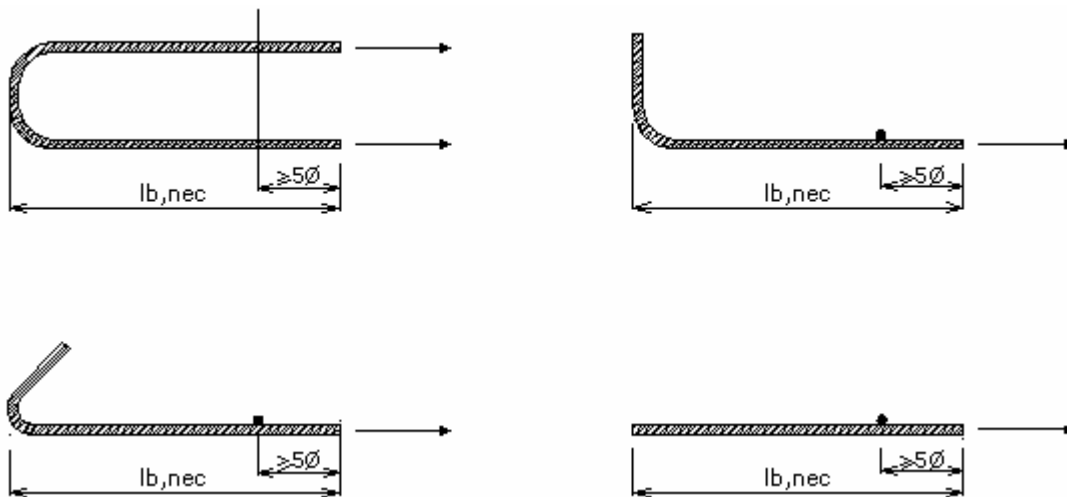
Ancoragem com barras transversais soldadas
